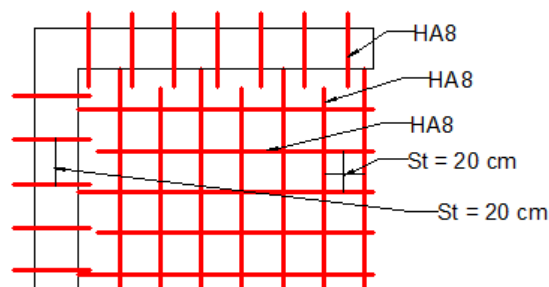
Ferrailage de la dalle sur 2 appuis perpendiculaire type 2.
